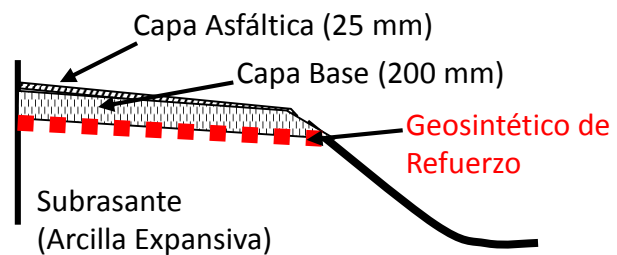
Sección típica de pavimento para una carretera de bajo volumen en Texas, usando refuerzo para mitigar fisuras inducidas por arcillas expansivas.
